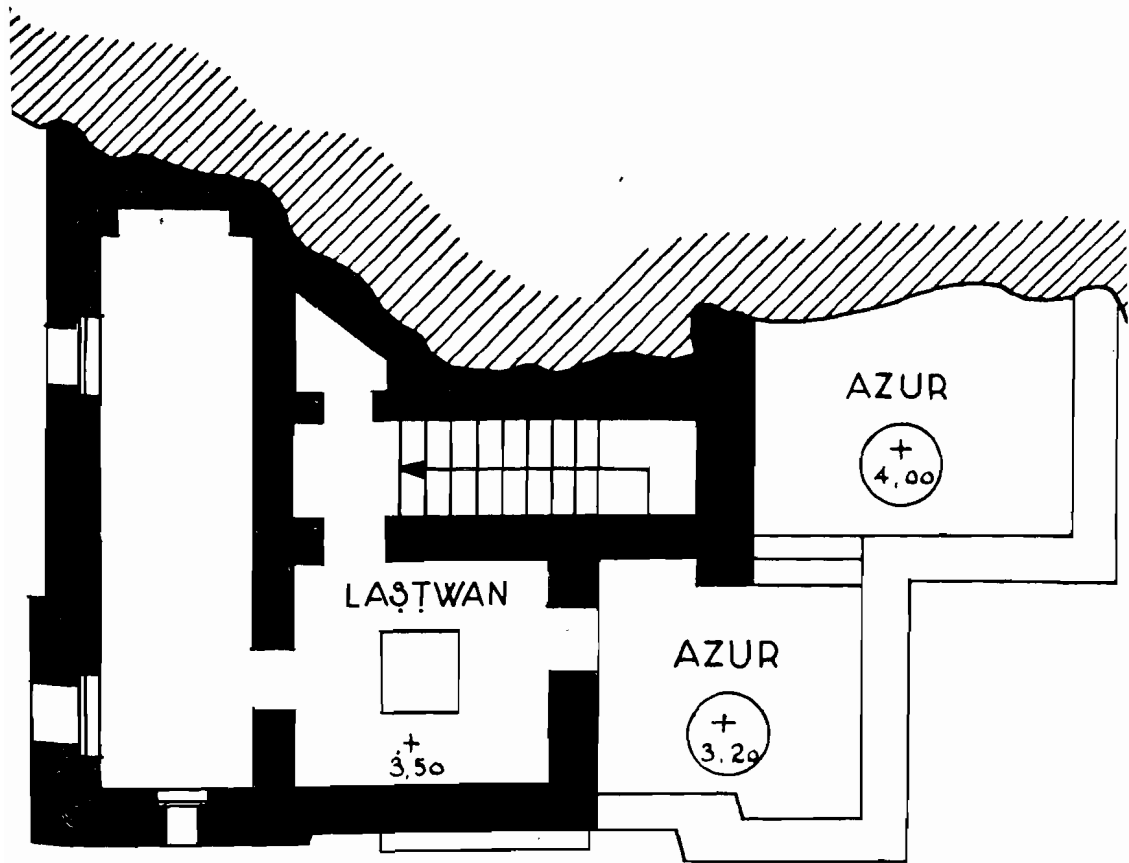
Maison d'Imi-Ane. Plan du *niveau haut*.
